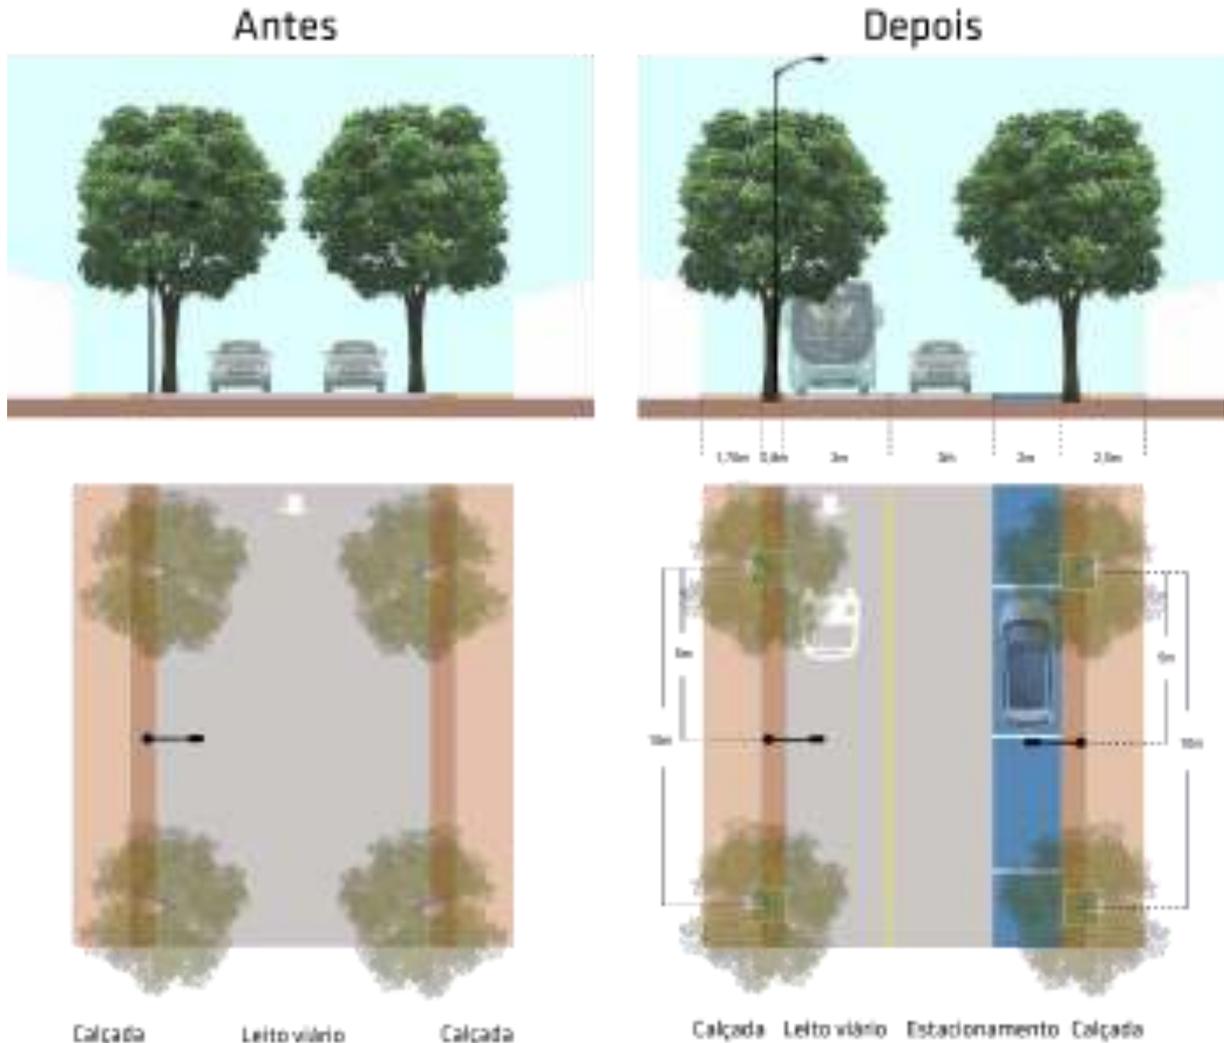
Proposta para a Seção E, Rua Dona Maria Tomásia. Fonte: Architectus.
